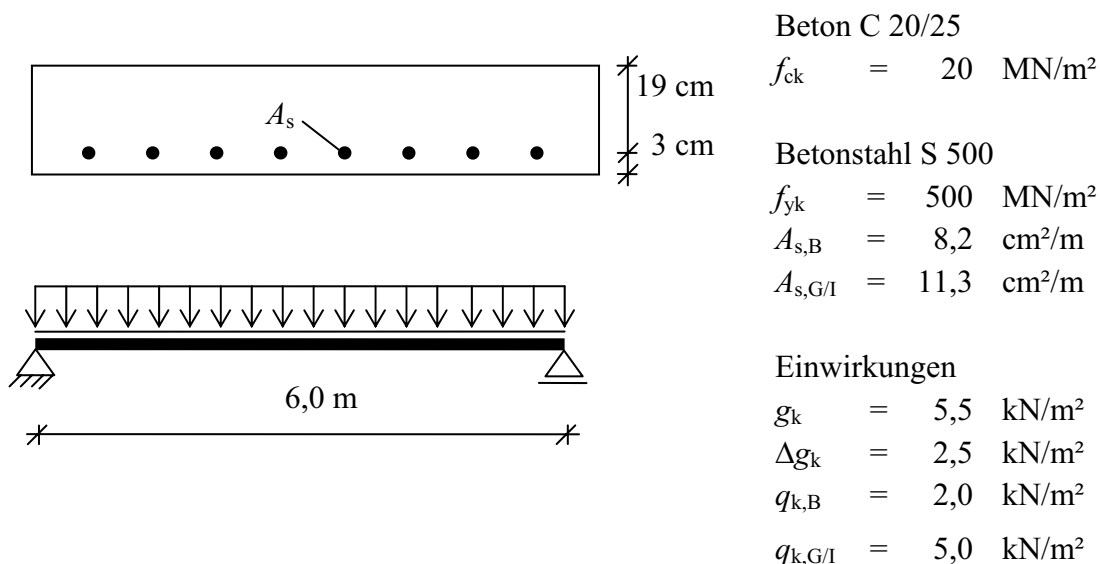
Unverstärkte Stahlbetonplatte – statisches System, Querschnitt, Baustoffe, Betonstahlbewehrung und Einwirkungen
